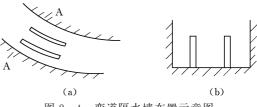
弯道隔水墙布置示意图 (a) 隔墩平面图; (b) 隔墩横剖面图
